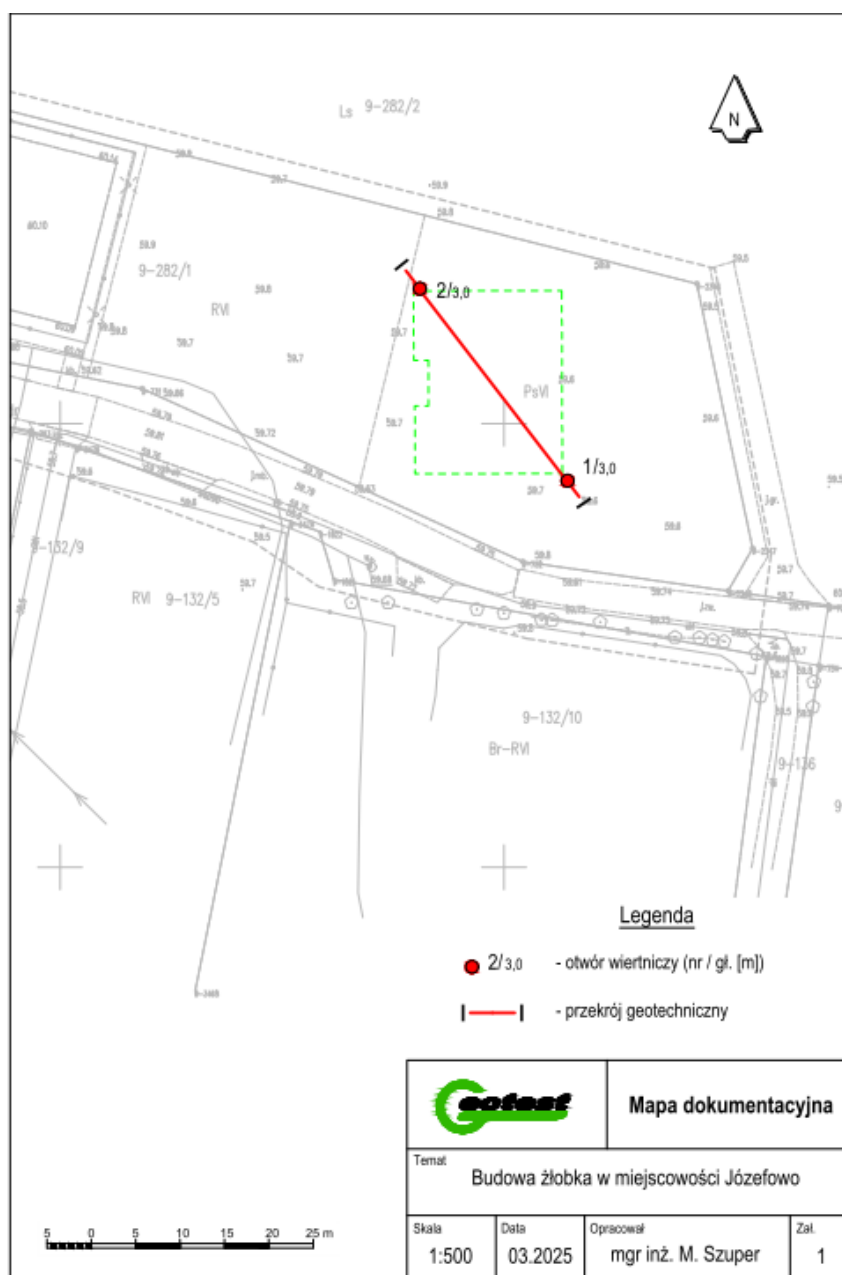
Fragment planu zagospodarowania terenu. Lokalizacja projektowanego obiektu.
